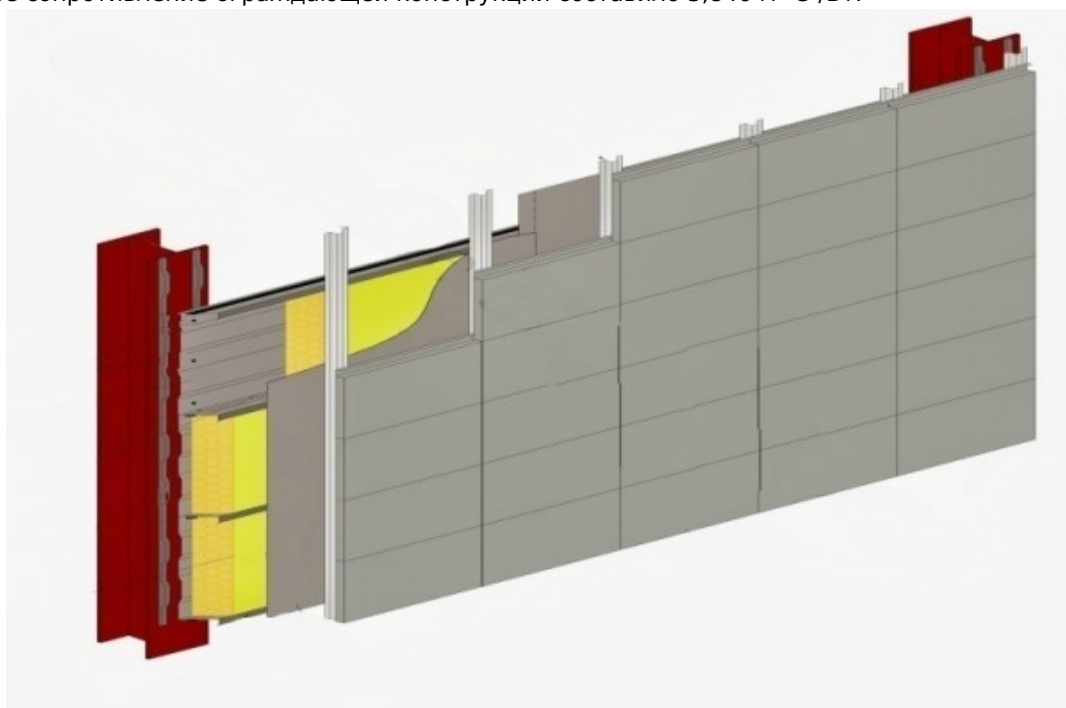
Разрез стены дома на основе каркаса из металла
